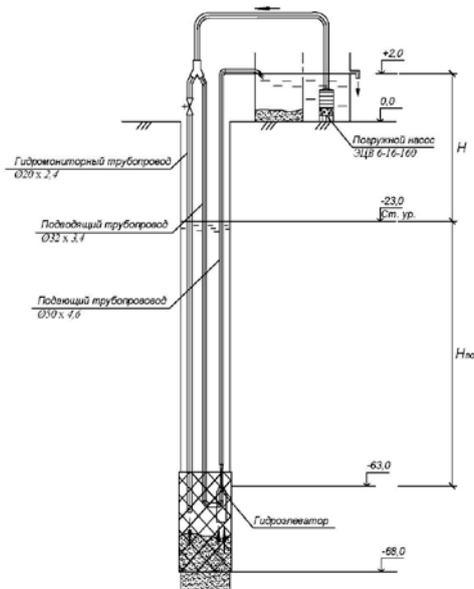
Расчетная схема гидроэлеваторной установки
